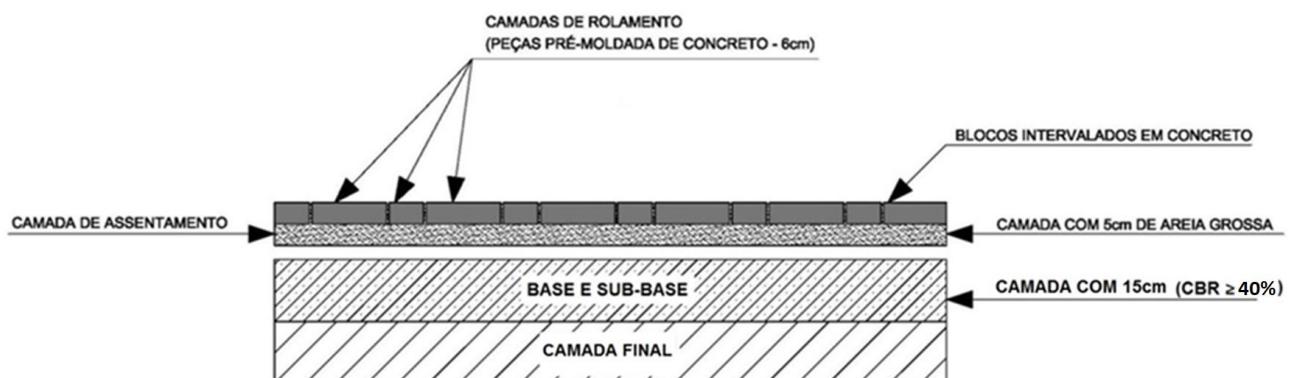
Detalhe da estrutura-tipo do pavimento em bloco intertravado – Vias Locais
